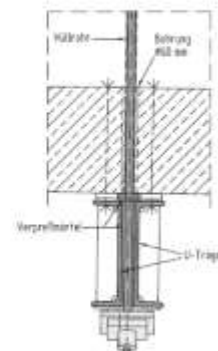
Querkraftverstärkung, Querschnitt und Details (Entwurfsplanung)
